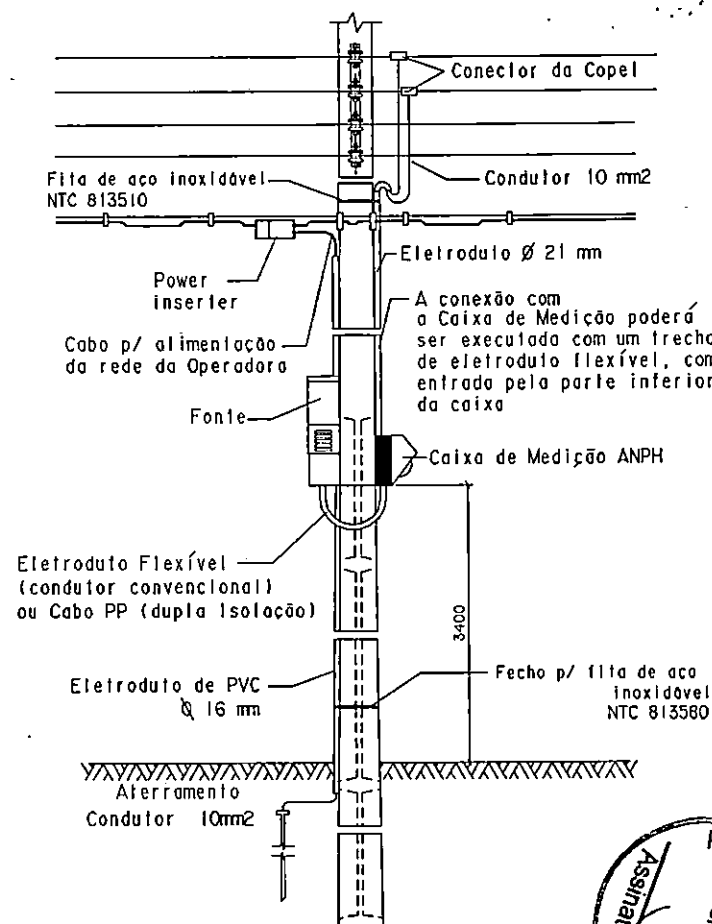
Instalação de Equipamento da OCUPANTE no Poste
